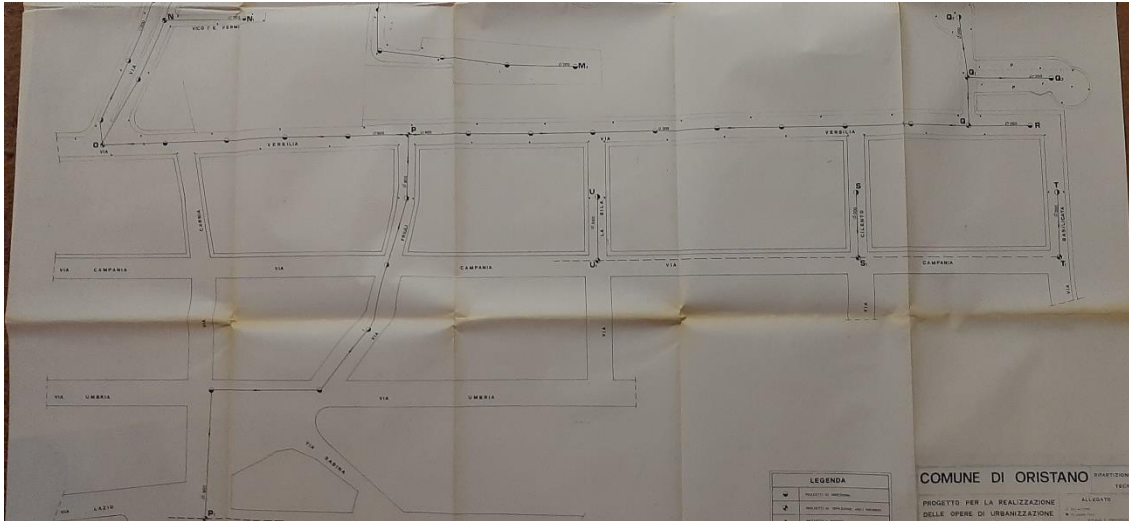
Planimetria progetto del '88 opere urbanizzazione Torangius.
